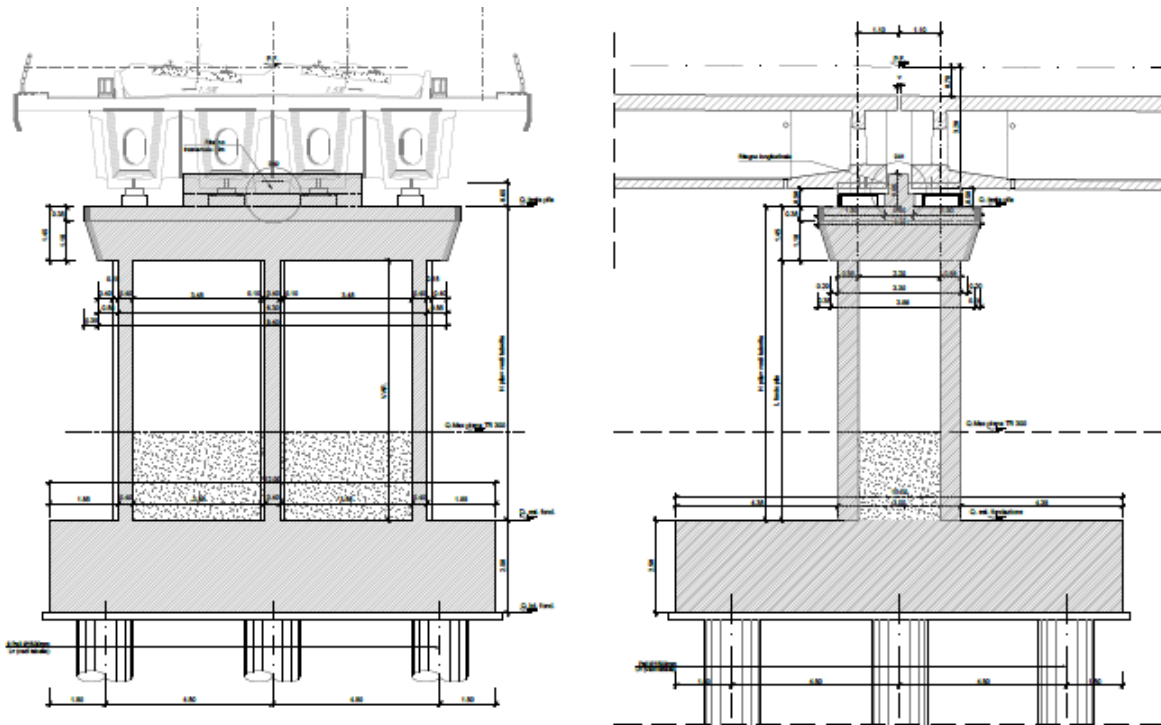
Sezione in direzione trasversale e longitudinale rispetto all'asse del viadotto
